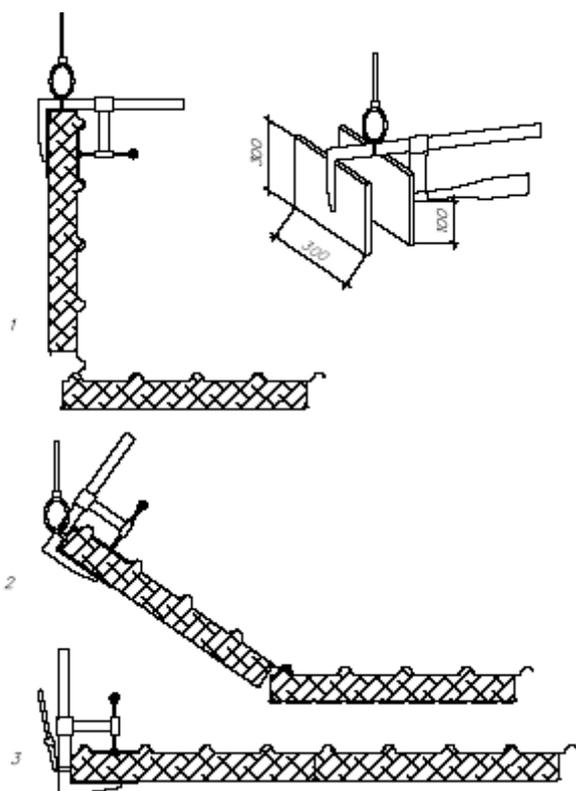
Транспортирование и укладка кровельных панелей на месте монтажа.
